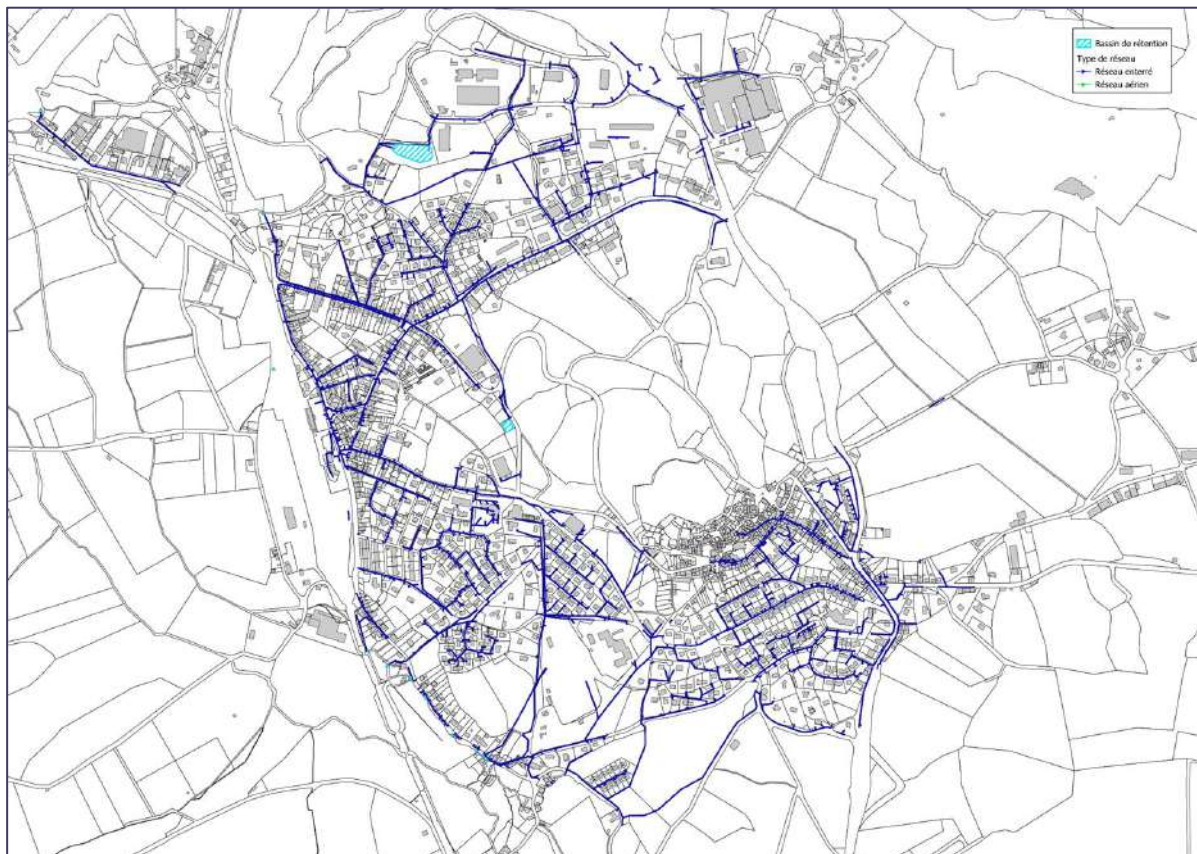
Plan du réseau pluvial de Séverac-le-Château – 31.2 km (plan SIG transmis par la commune)
